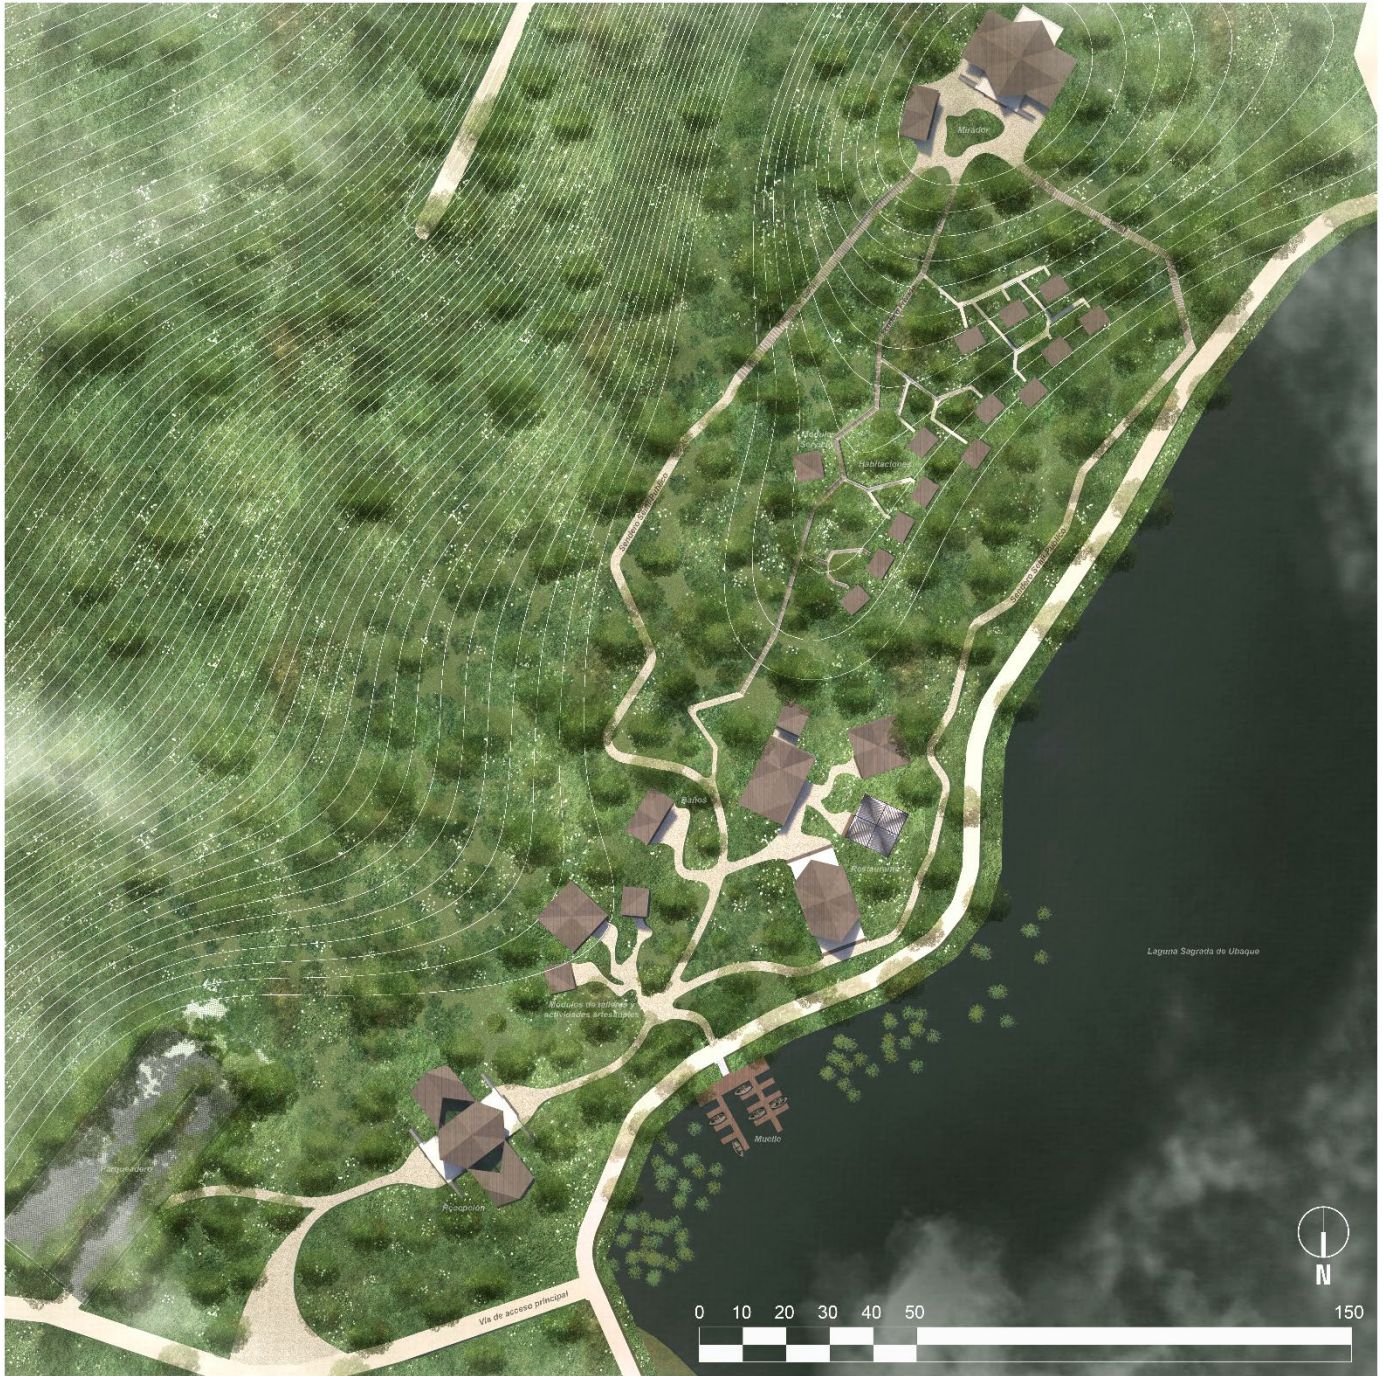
Planta general del proyecto: Centro de visitantes y Refugio de descanso
